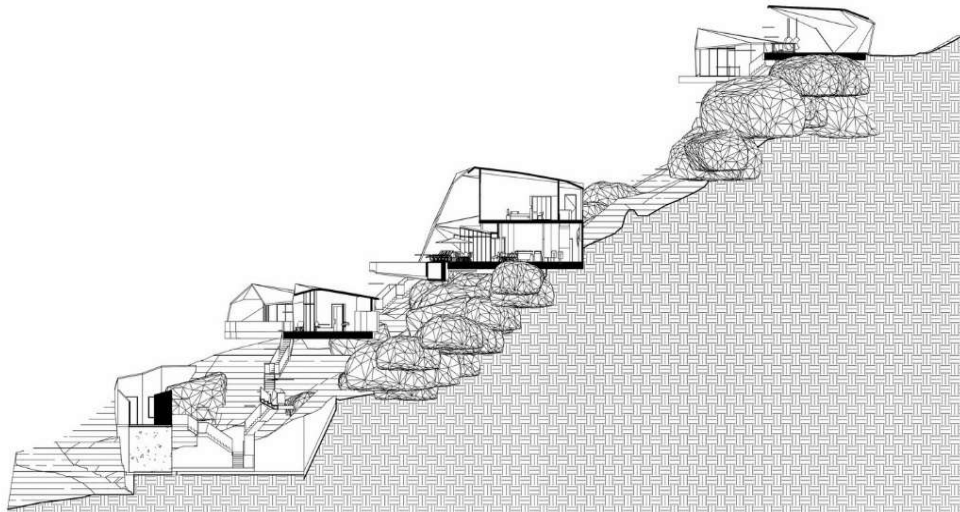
16 Site plan hotel resort Suan Kachamudee
